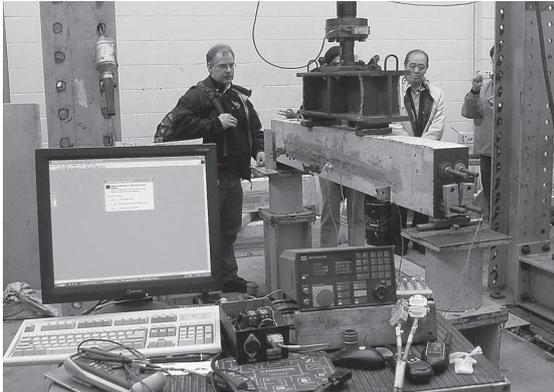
補修後のコンクリート構造物の強度を確認するための実験
